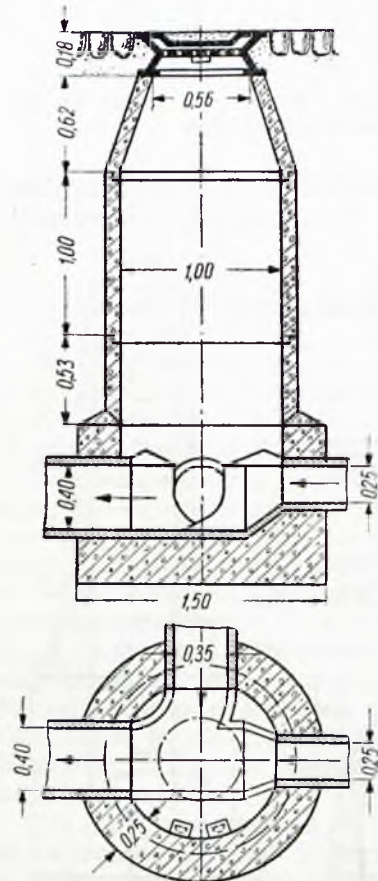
Studzienka włazowa z betonu ubijanego w wykopie
